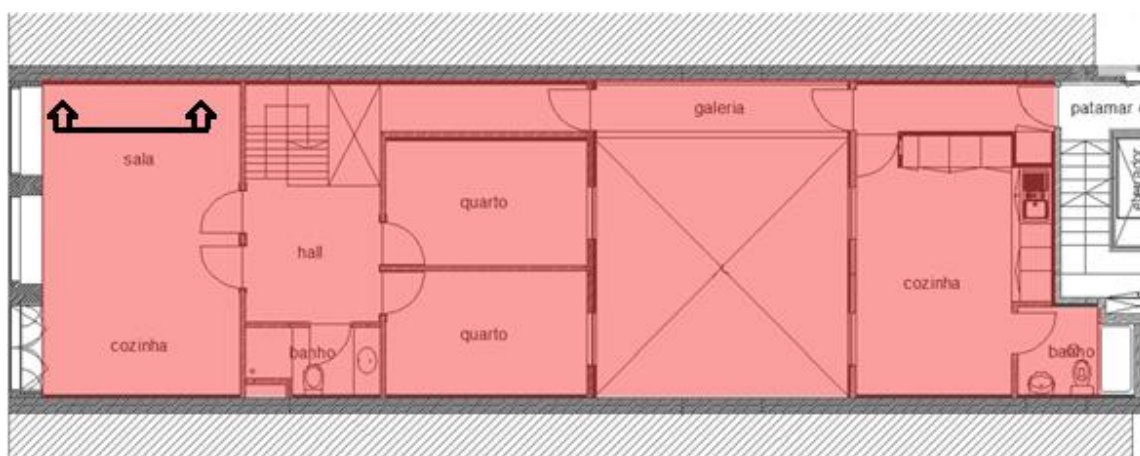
Marcação da zona de corte da laje na planta (Adaptado das peças desenhadas do Edifício do Caso de Estudo)
